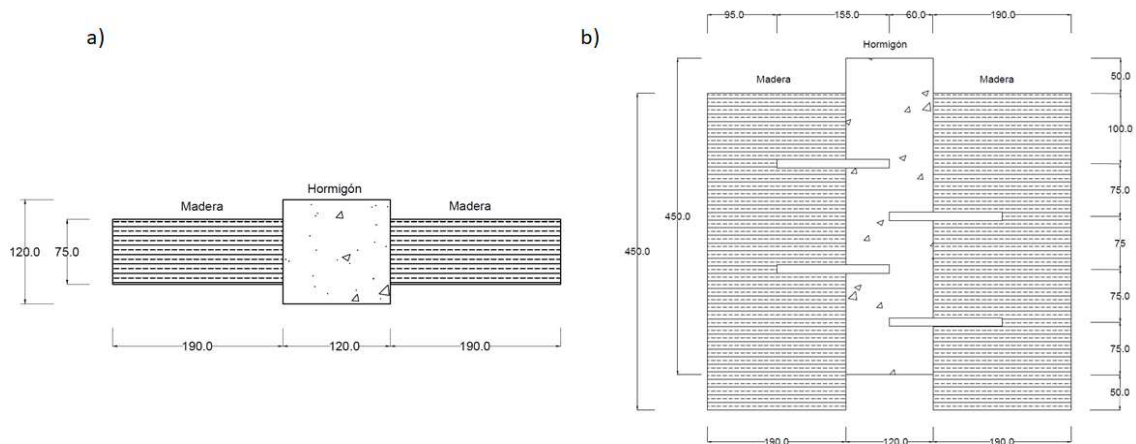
a) Planta y b) alzado, esquemáticos, de las probetas (unidades en [mm])
